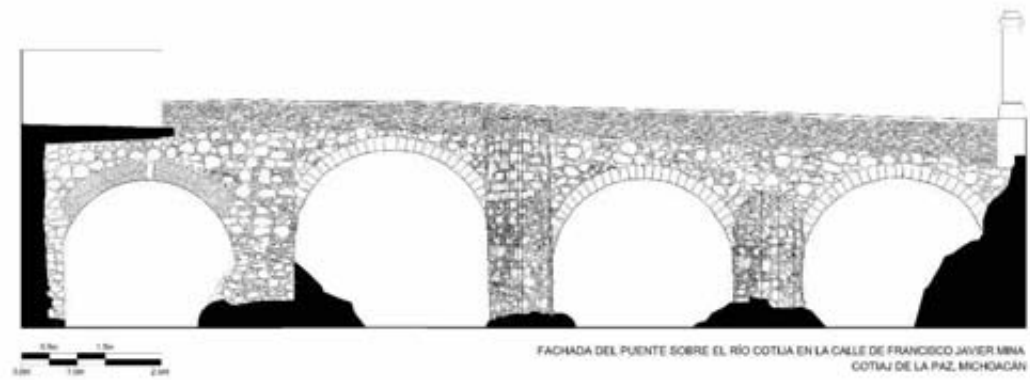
Planta del puente sobre el Cotija. Calle Francisco Javier Mina
